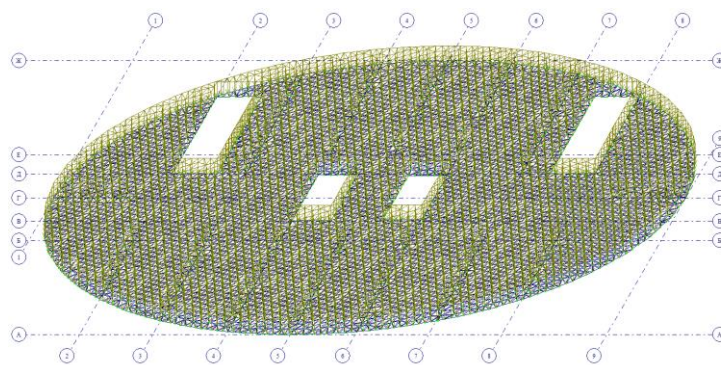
Схема плиты перекрытия с приложенными нагрузками
